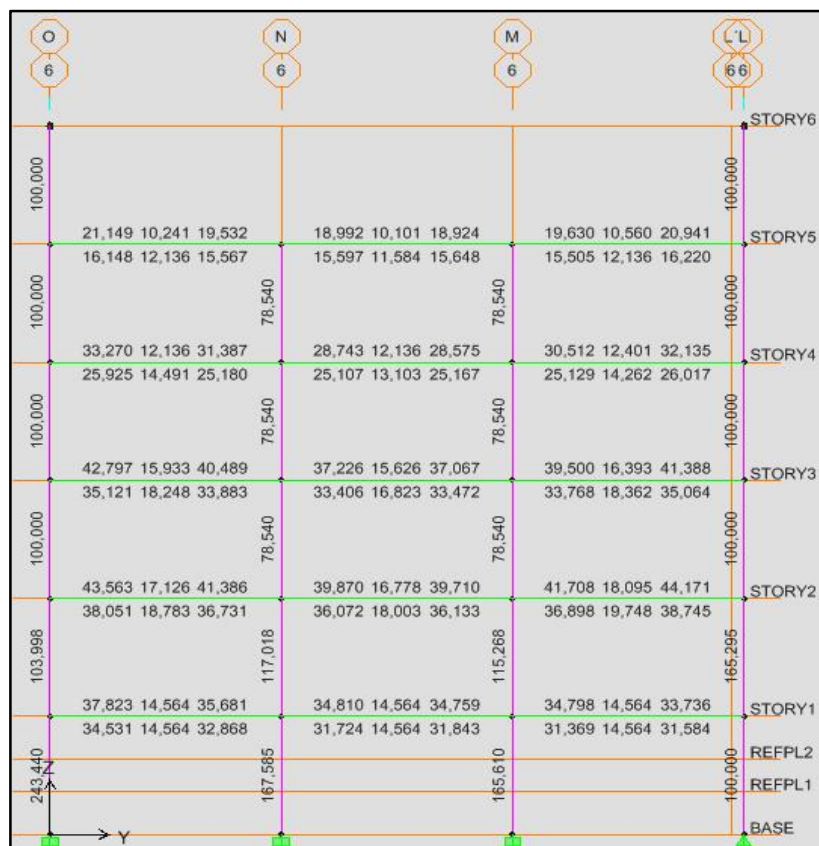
Acero en vigas pórtico 6, Gobernantes
